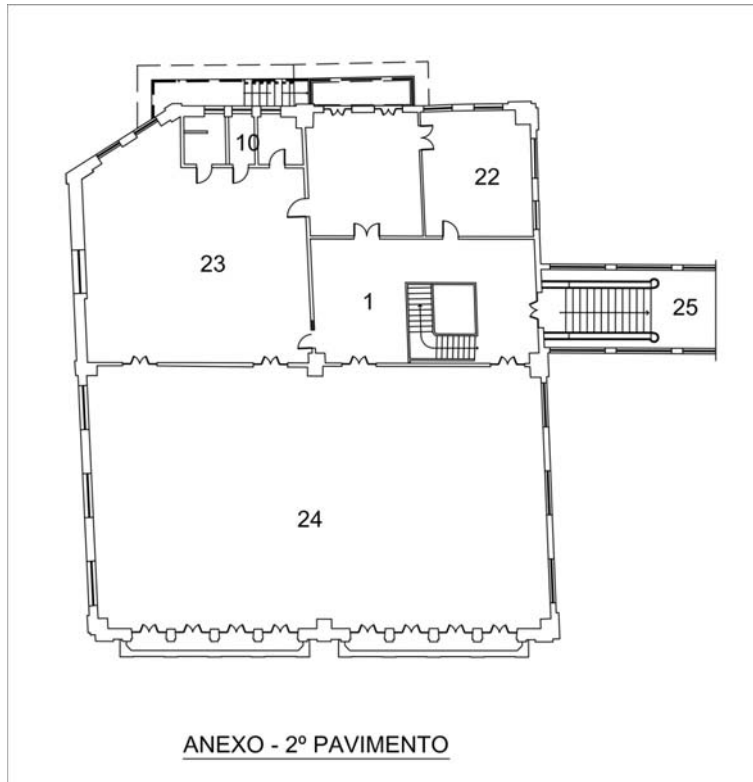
Planta hipotética do 2º Pavimento do prédio anexo – restaurante – sem escala.
